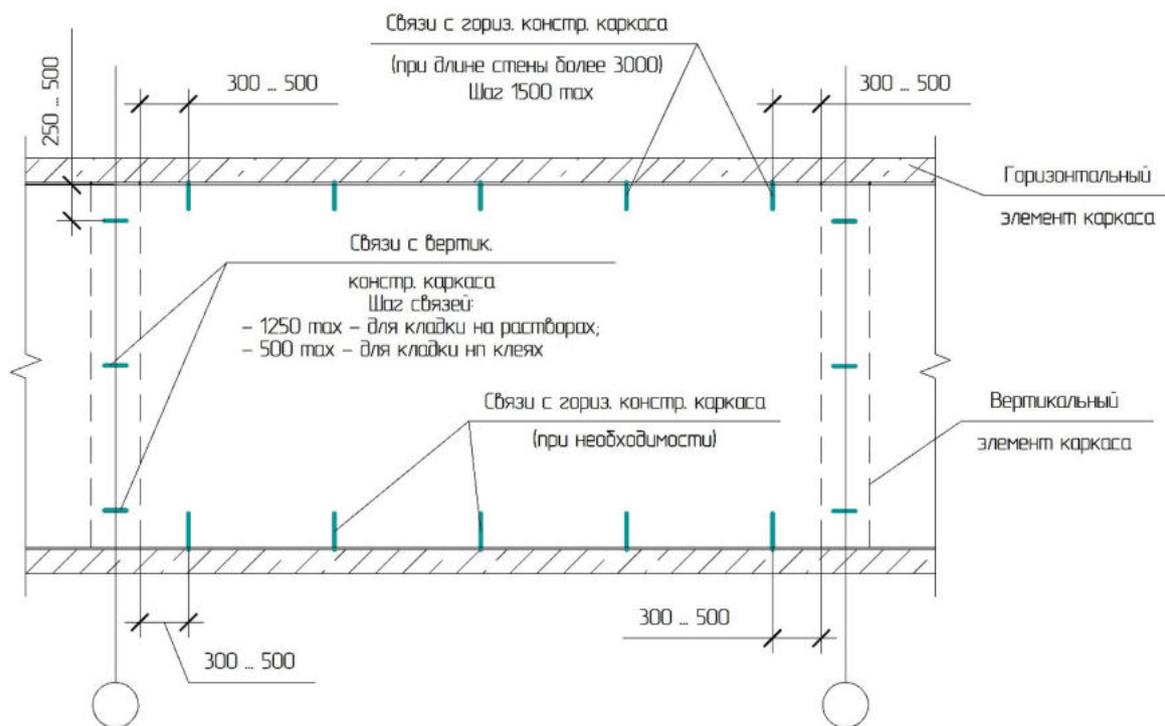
Схема расположения связей наружных и внутренних стен с элементами каркаса здания
